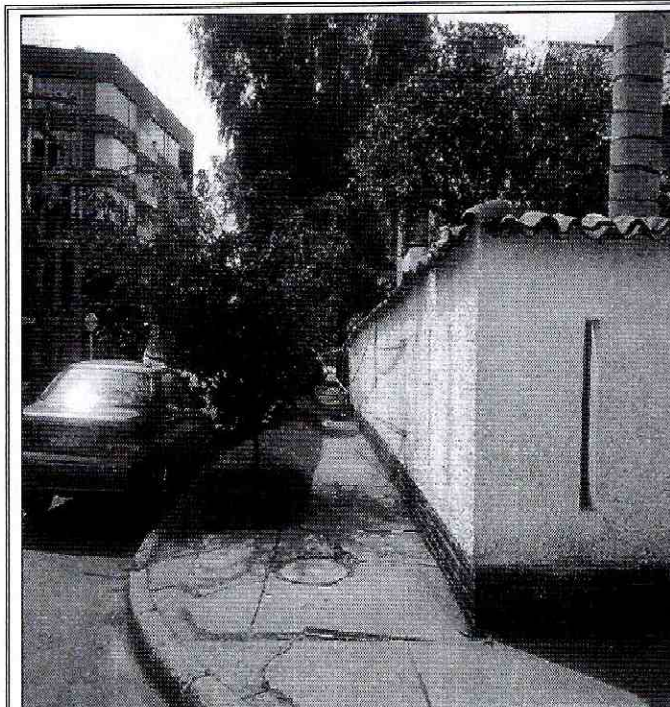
Desplazamiento lateral de la cubierta de la vivienda del predio de la Calle 104 No. 58 A – 12, en el Sector Catastral Puente Largo de la Localidad Suba.
